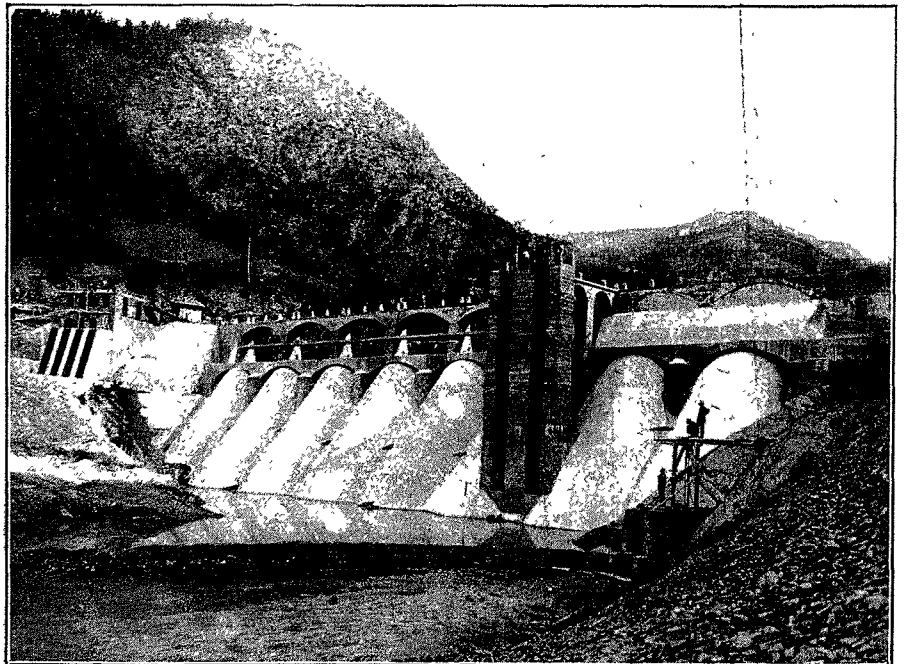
Vue générale de l'ouvrage terminé (au premier plan, à la droite du lecteur, les bondes de fond et leur passerelle de manœuvre; au fond, à sa gauche, la prise d'eau, surmontée par la maison du gardien).
